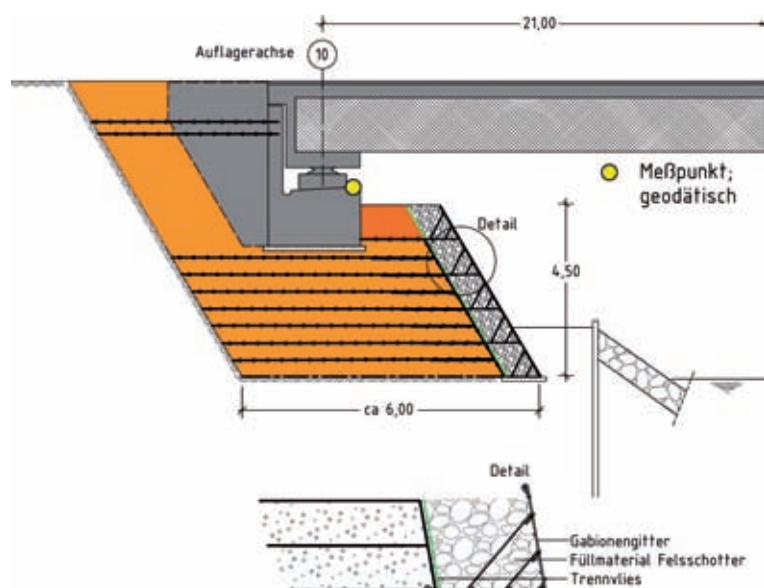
Regelquerschnitt des bewehrten Brückenwiderlagers bei Ilsenburg [2] mit Kennzeichnung der Hauptelemente einer KBE-Konstruktion
